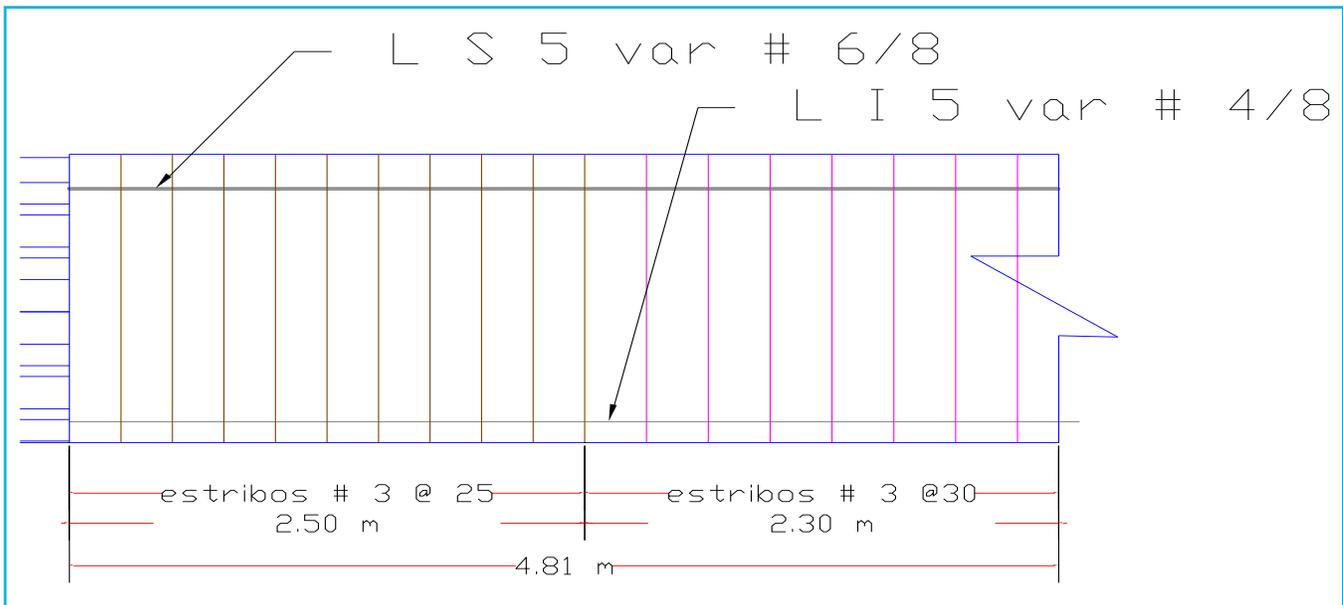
esquema de la distribución de los estribos en los primeros 4.81 metros de la viga.
